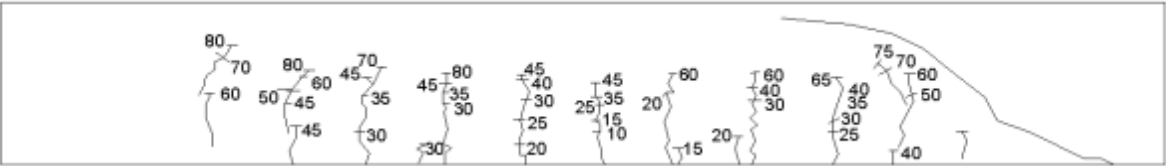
Mapa de fissuras da Viga V4A150
